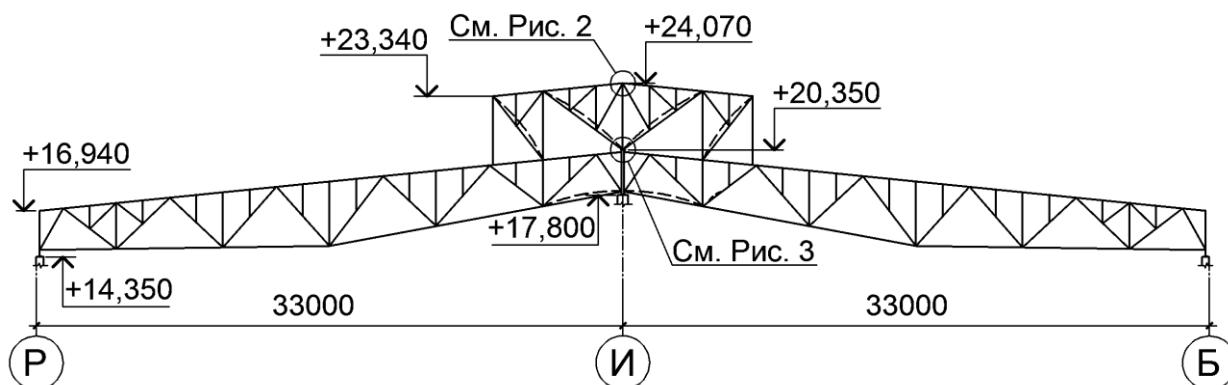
Схема стропильных ферм и фонаря склада сырья
